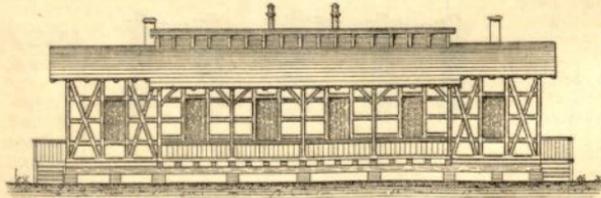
Baracke des Krankenhauses zu Halberstadt.
